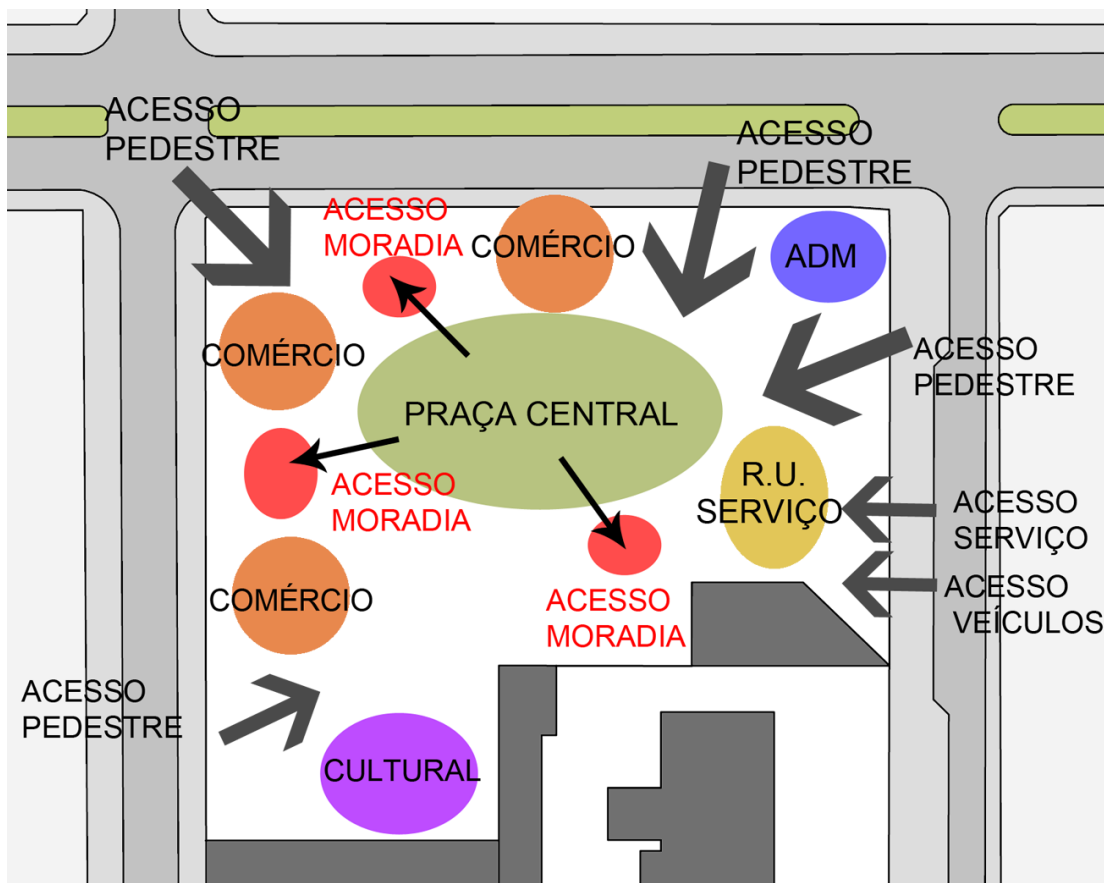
Plano de ocupação. Fonte: (AUTORA, 2014)
